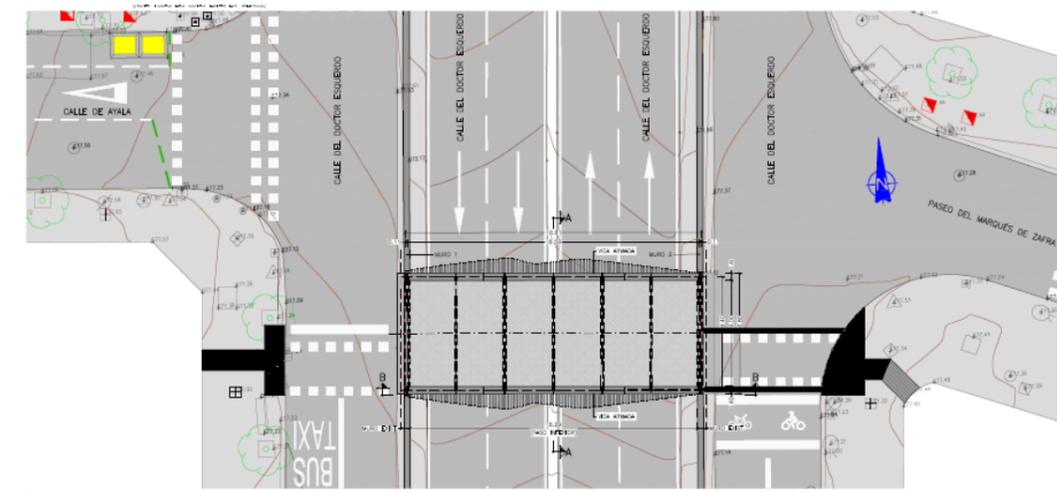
Planta de la pasarela peatonal. Fuente: Proyecto
